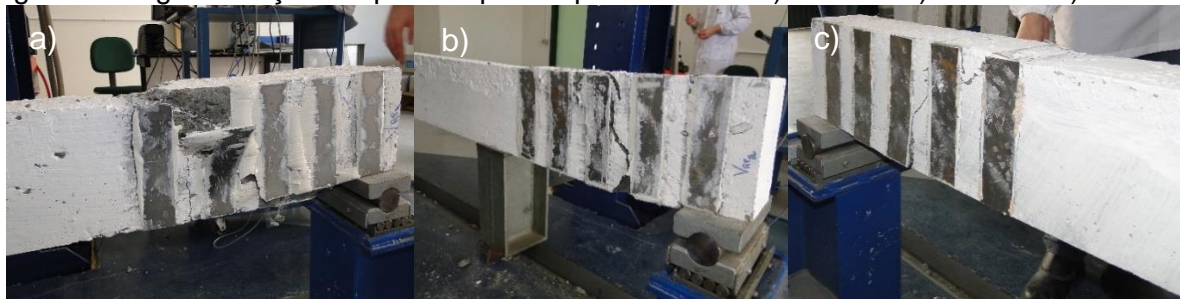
Viga sã reforçada após o ensaio – VRF3. a) Visão geral da viga. b) Detalhe das fissuras.
